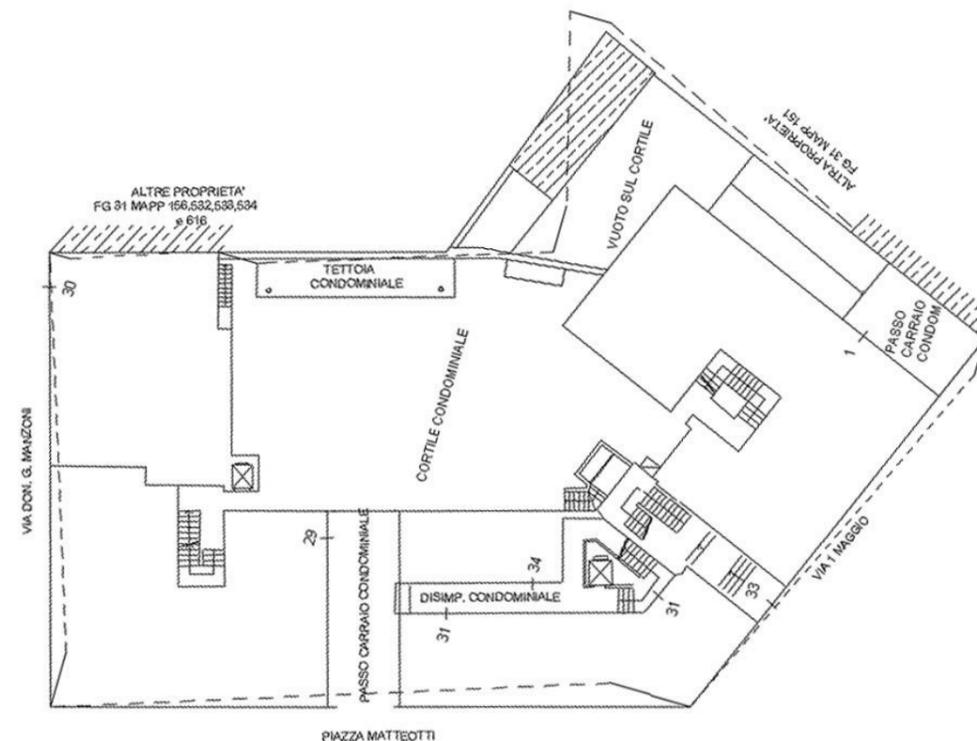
Estratto dal catasto – stralcio dell'elaborato planimetrico relativo al piano terra dello stabile
